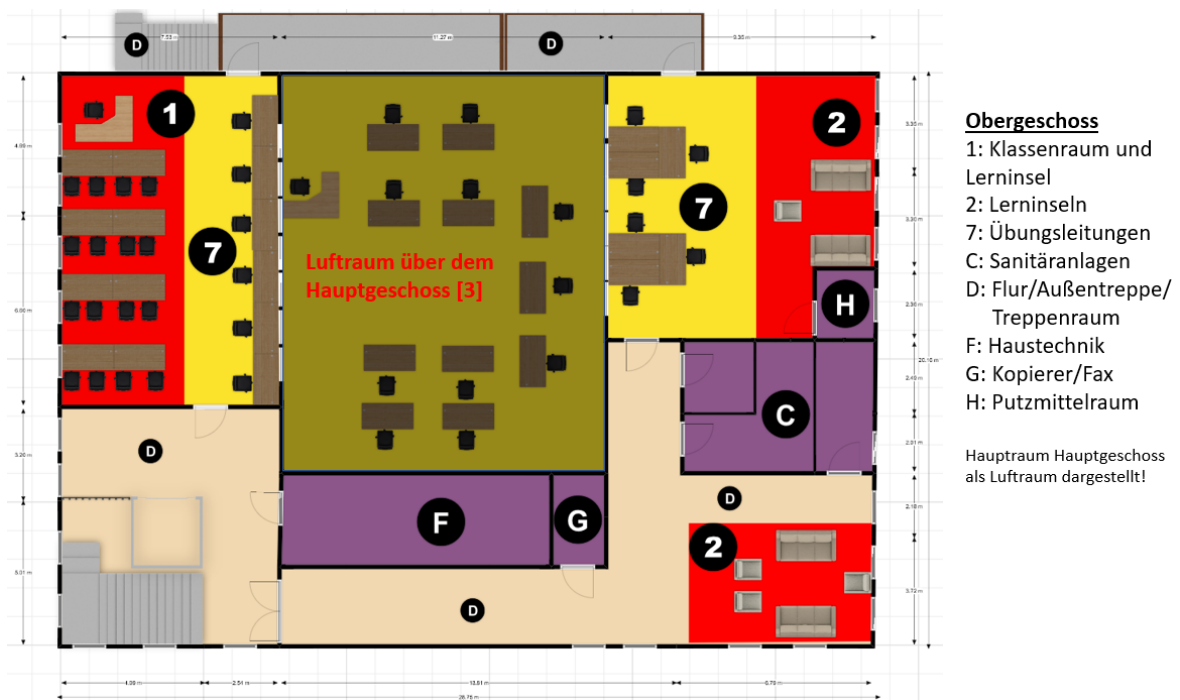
Obergeschoss (erstellt mit Floorplanner)
